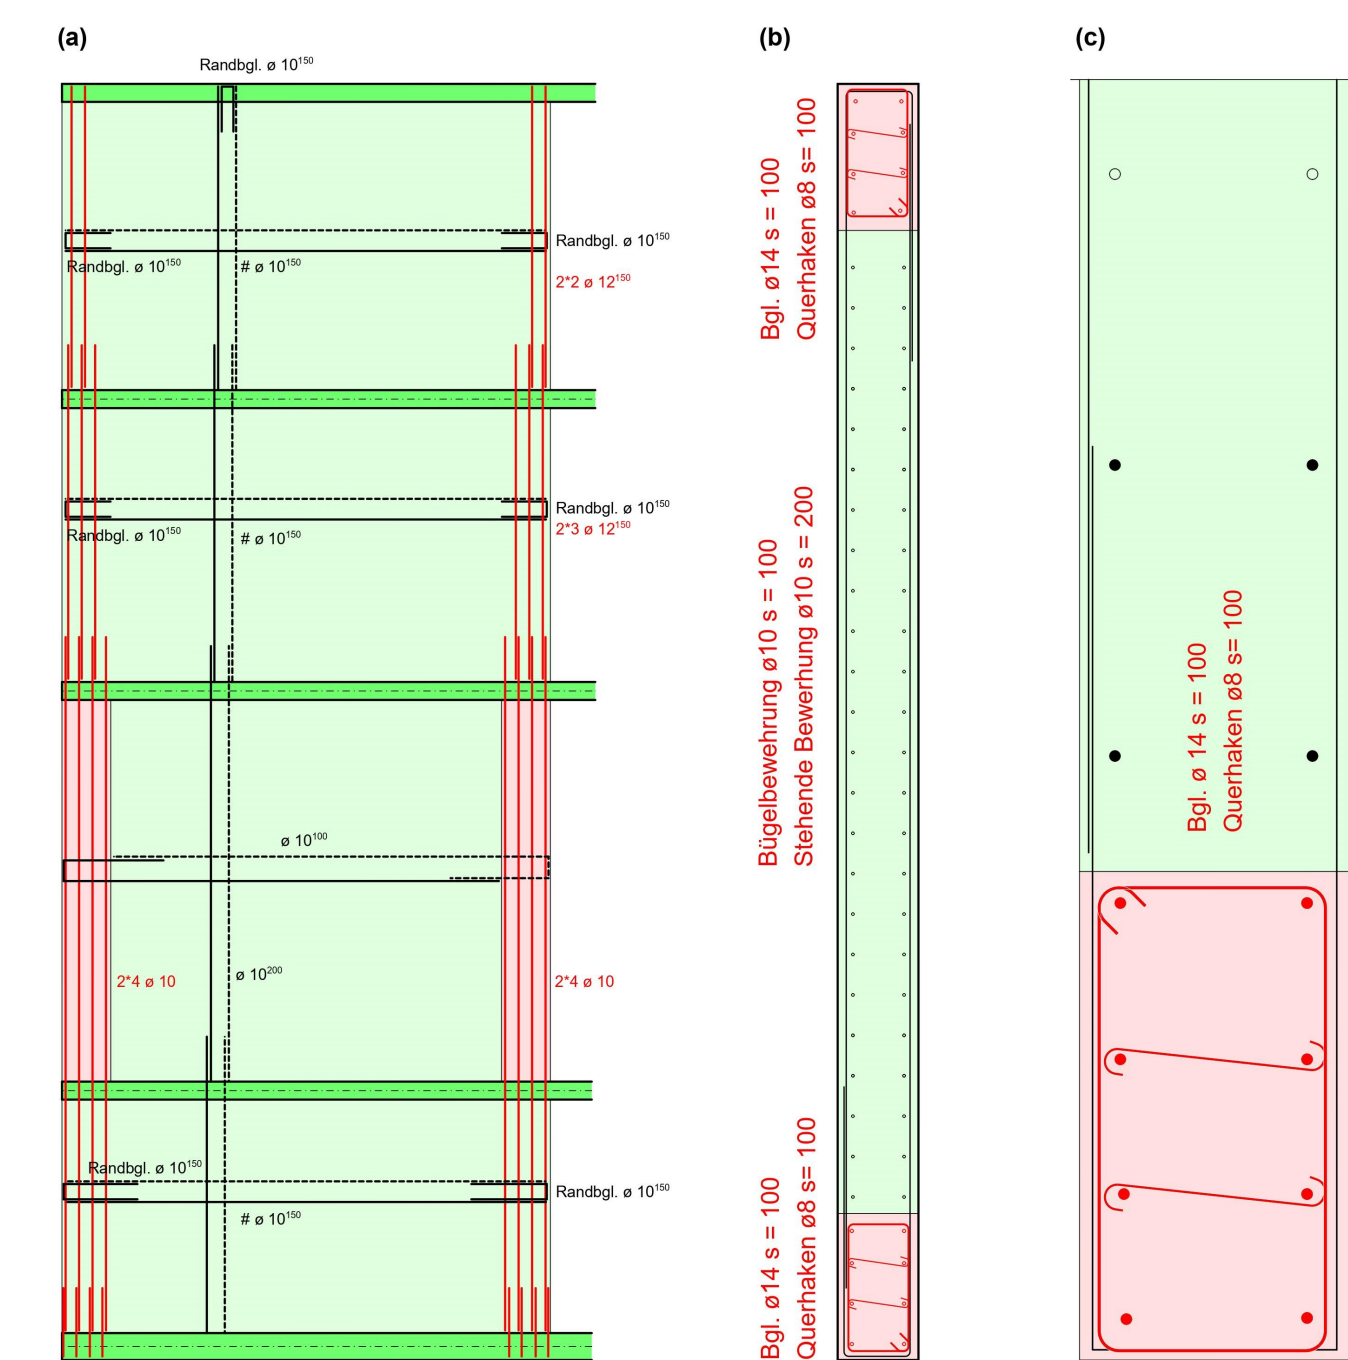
(a) Bewehrung Tragwand, (b) Bewehrung plastische Zone im Erdgeschoss (c) Randbereich mit konstruktiver Verbügelung (Eigene Darstellung)
